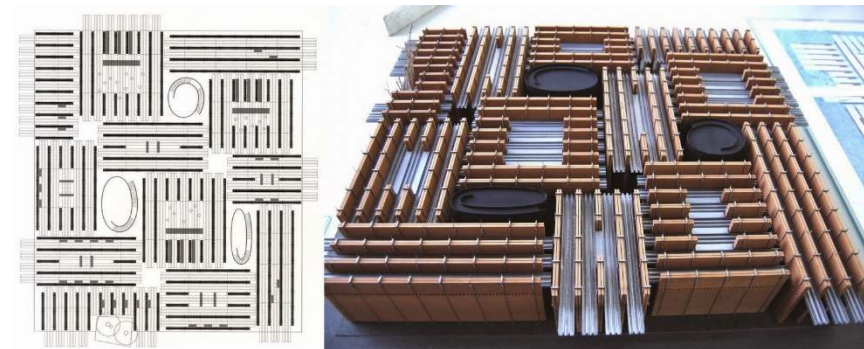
Planta Arquitectónica, Foto aérea de maqueta del proyecto.
